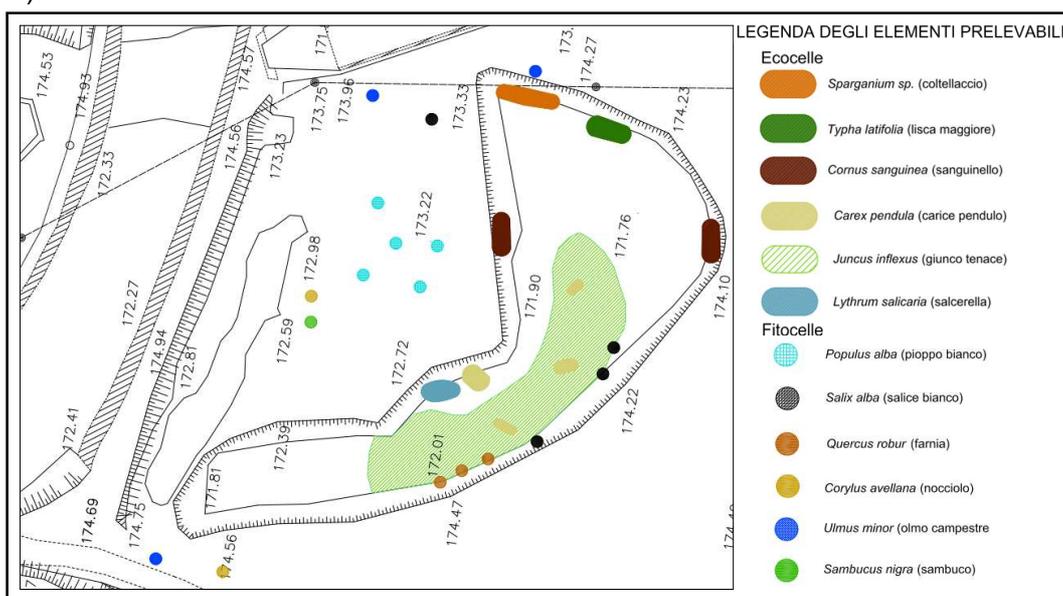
Stralcio Planimetria materiali da trapiantare - 2.6E-dF 2.1.67.00
